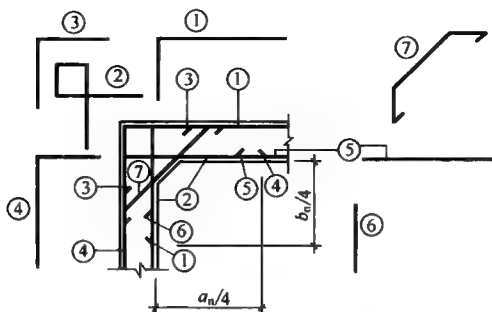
仓下支承柱不伸到仓顶的仓壁水平配筋示意
